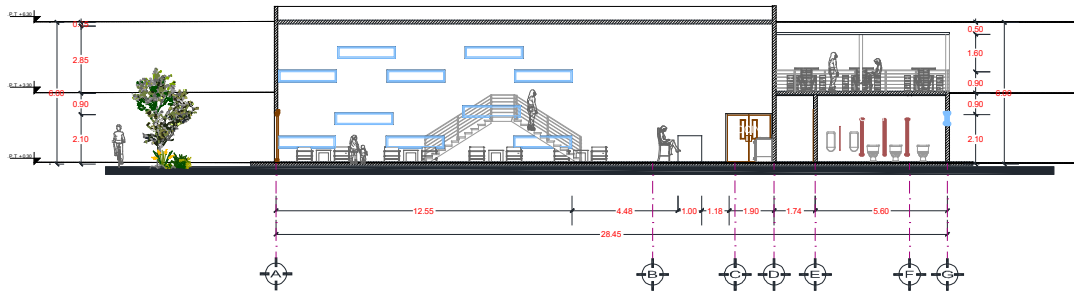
Propuesta Restaurante, Sección C-C' (Anexos Plano: 6-CORT-REST-02)
